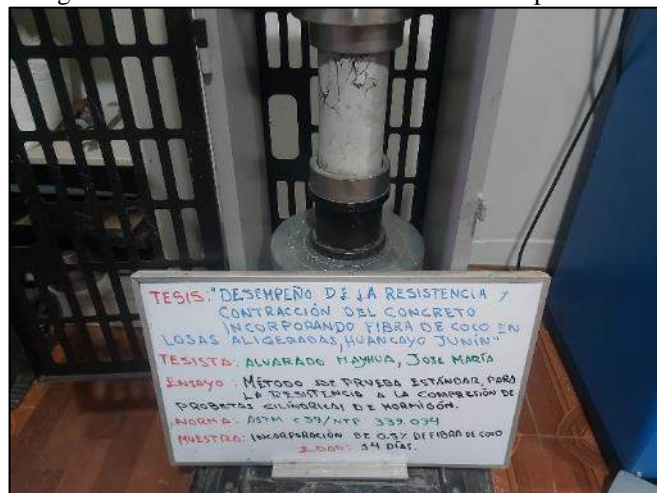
Vista de la medición de las fisuras en el concreto.
